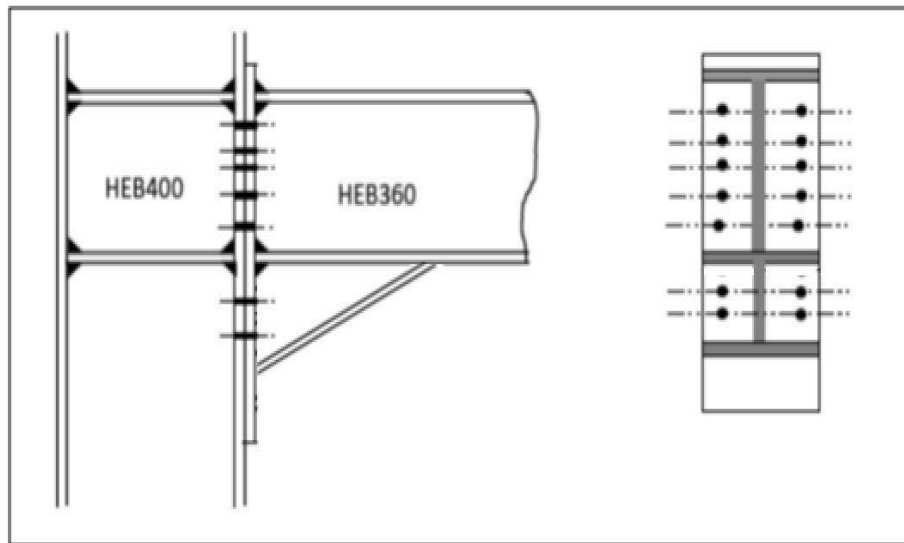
Assemblage poutres - poteaux (HEB360- HEB400)
